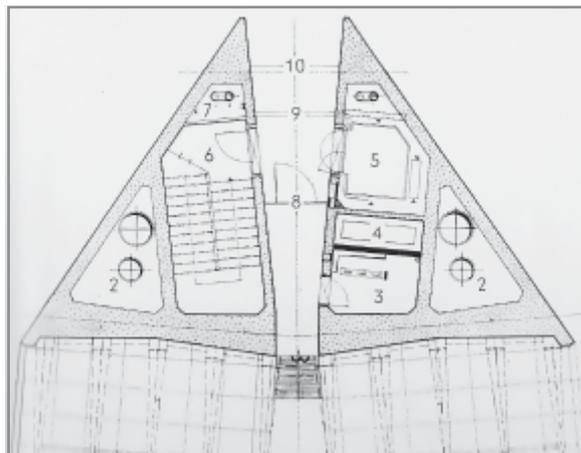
Pirelli Administration Building, 1956-60 - Fonte: Office Buildings, HOHL, 1968, página 133.
